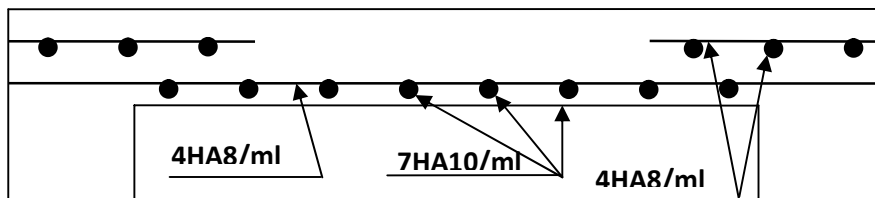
Schéma de ferrailage du sixième type de balcon.
